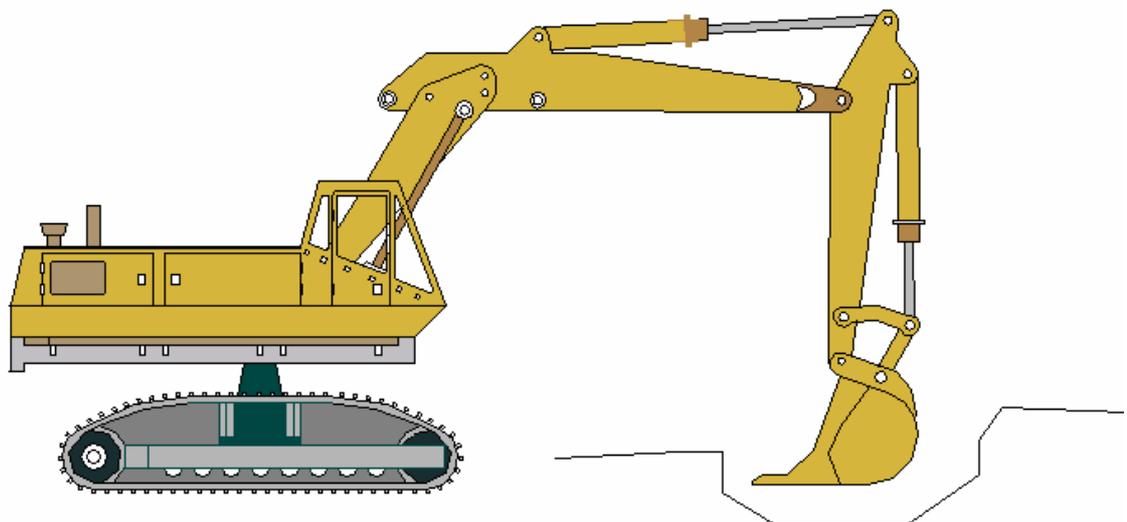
Realización de una prezanja de excavación con una retroexcavadora./Elaboración Propia.
